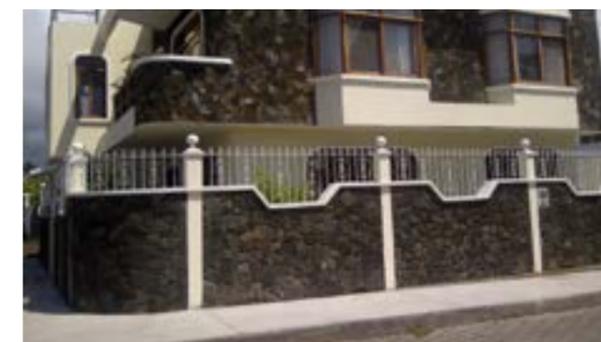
Piedra bloque en cerramiento. Fuente: Ing Darwin Gallardo
